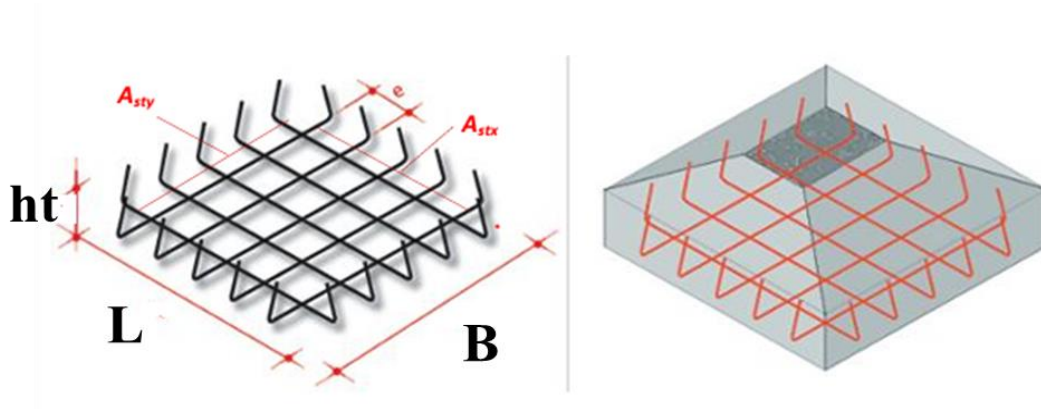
Exemple de disposition de ferrailage pour une semelle isolée.
